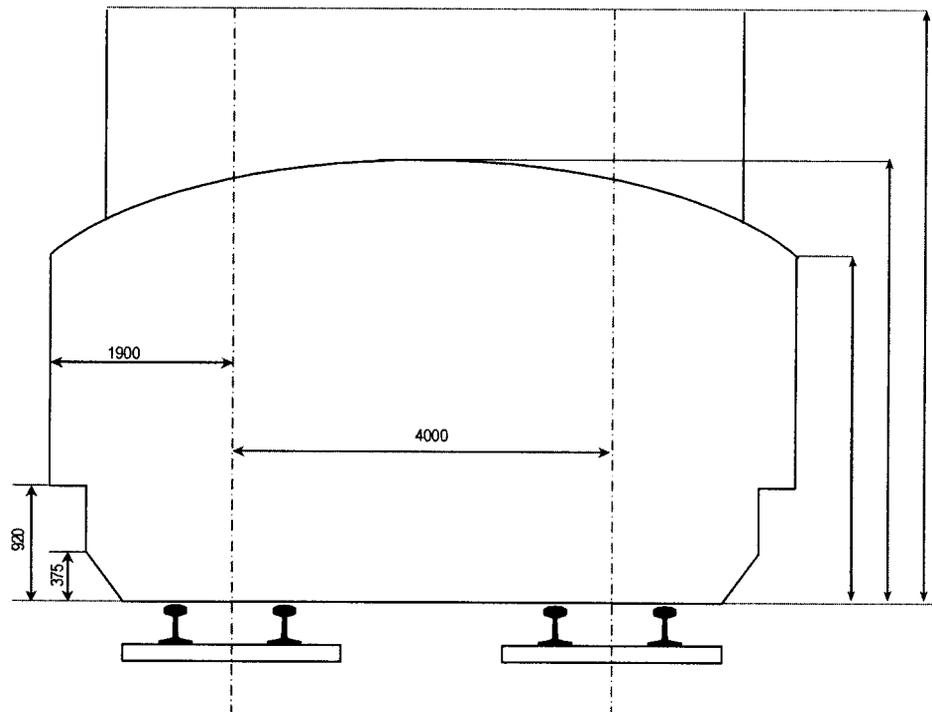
Ruang Bebas lebar jalan rel 1067 mm pada Lengkungan
